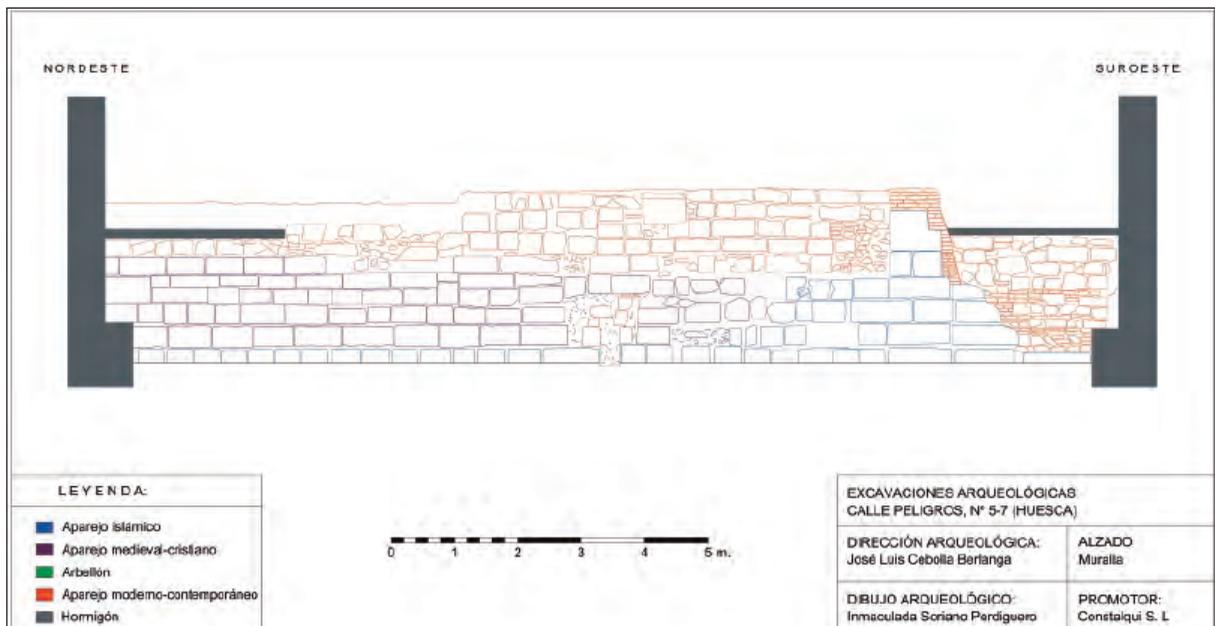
Alzado de la muralla de la calle Peligros, n.ºs 5-7.
